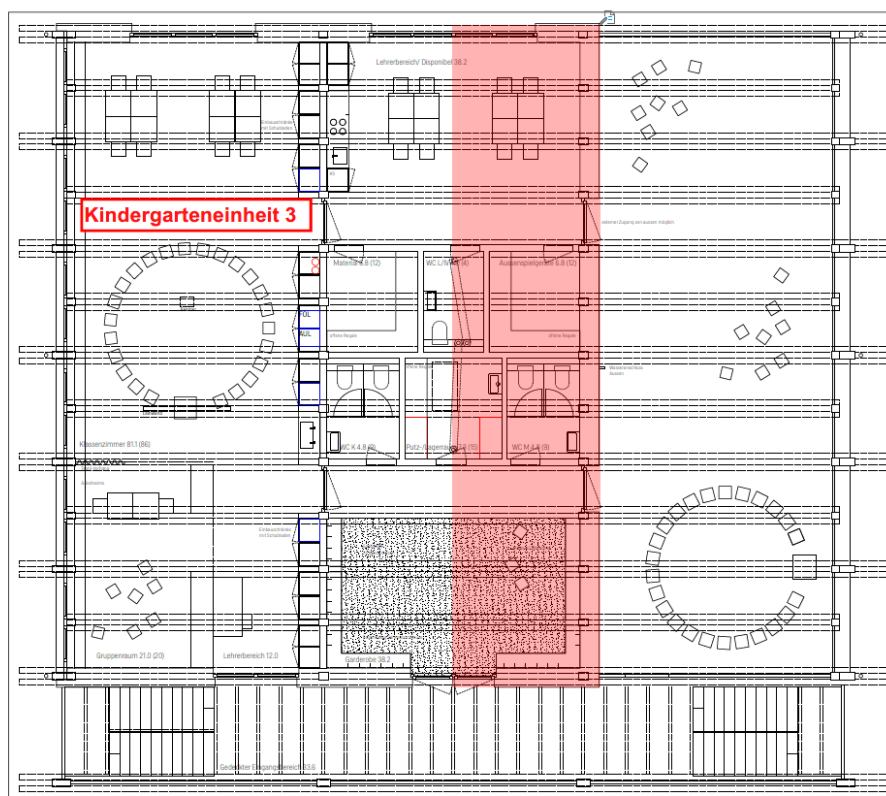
Grundriss Obergeschoss mit Kinderteneinheit 3 (Herleitung Punkt 1 und 2, Raumoptimierung)
